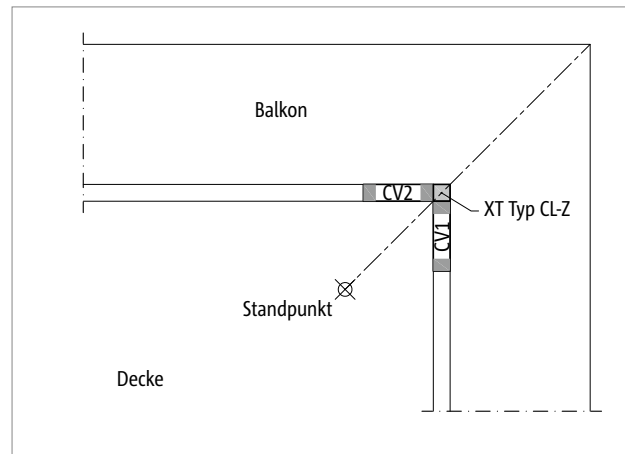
Schöck Isokorb® XT Typ CL: Betondeckung wählbar: Hier CV2 links vom Standpunkt, Betondeckung CV1 rechts vom Standpunkt
